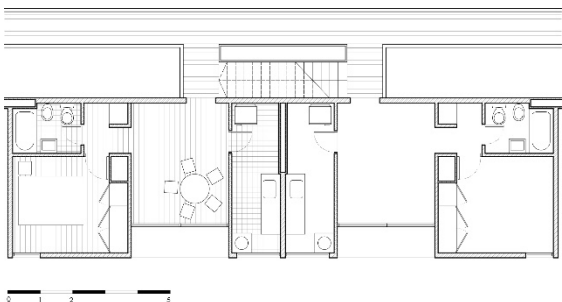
Conjunto Rioja. Planta tipo puentes de interconexión. Elaboración del autor.
